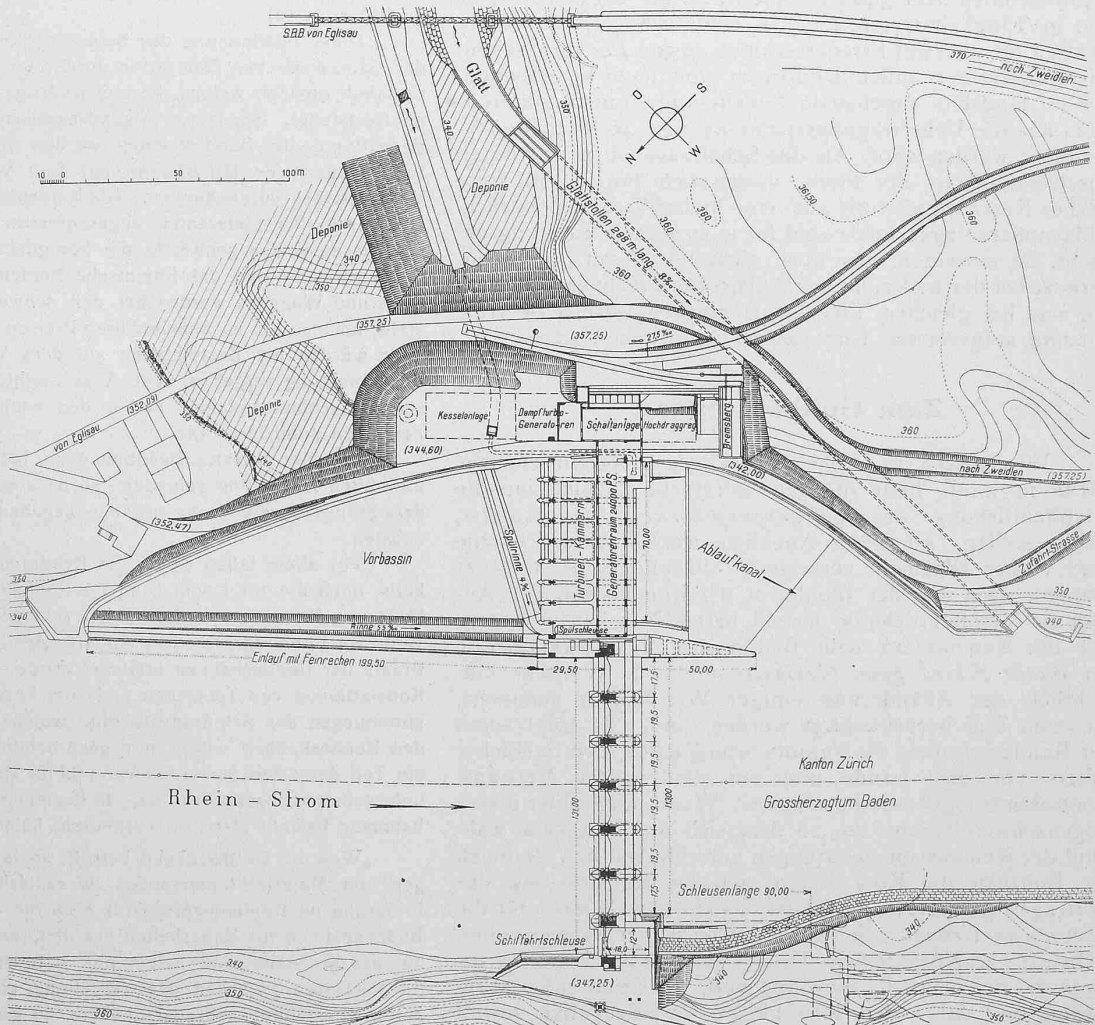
Lageplan des Kraftwerks Eglisau. — Masstab 1 : 3000.
